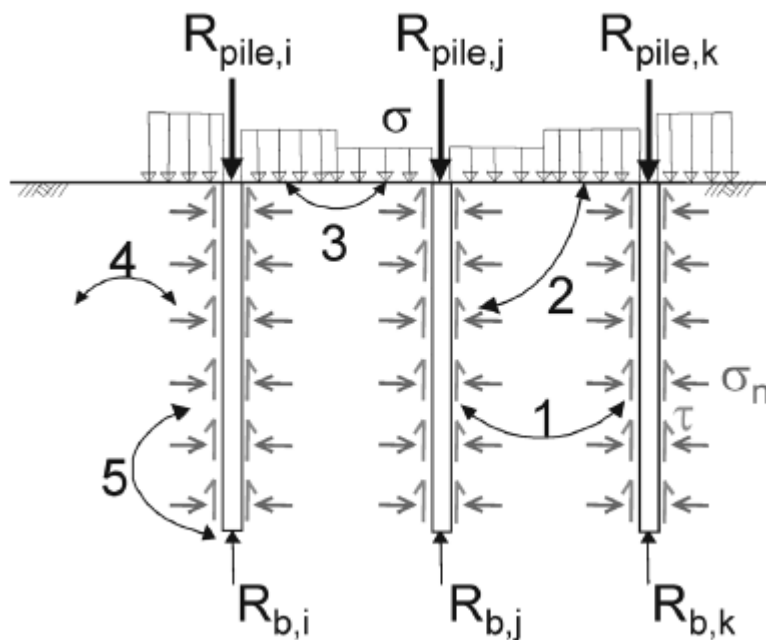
Ilustrasi penurunan yang terjadi pada fondasi tiang-rakit
